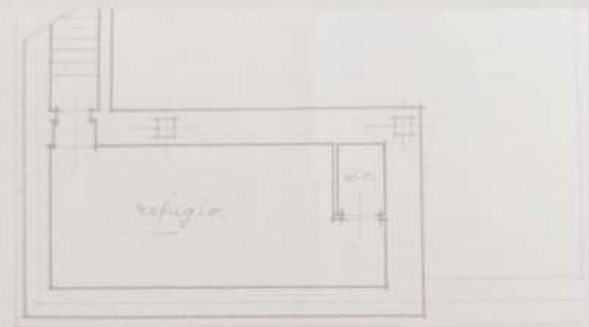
Planta y secciones de refugio para edificio en General Franco 60.
